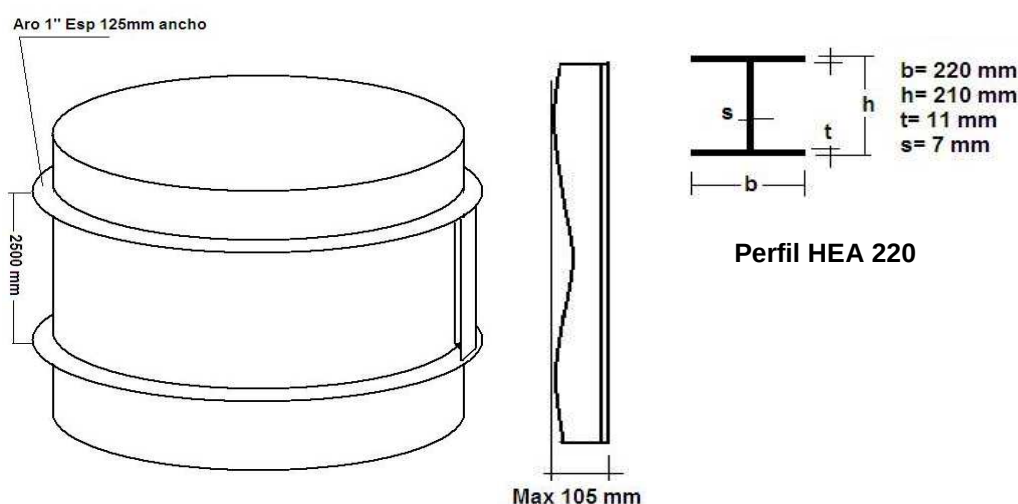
Detalles del arreglo y tipo de refuerzo a instalar
